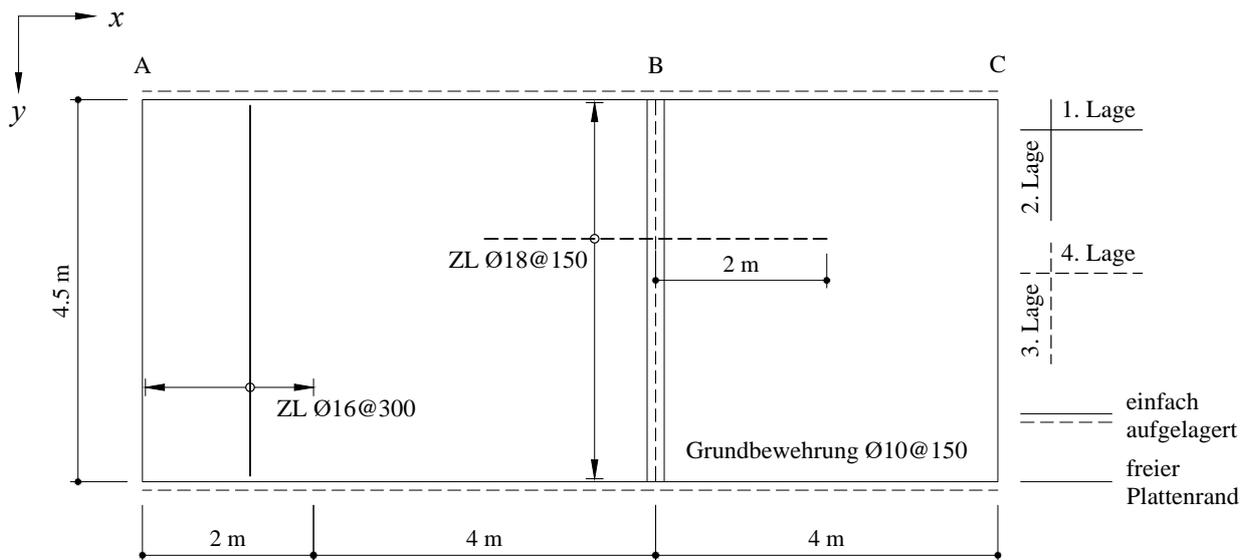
Grundriss der Platte und Bewehrungslayout
